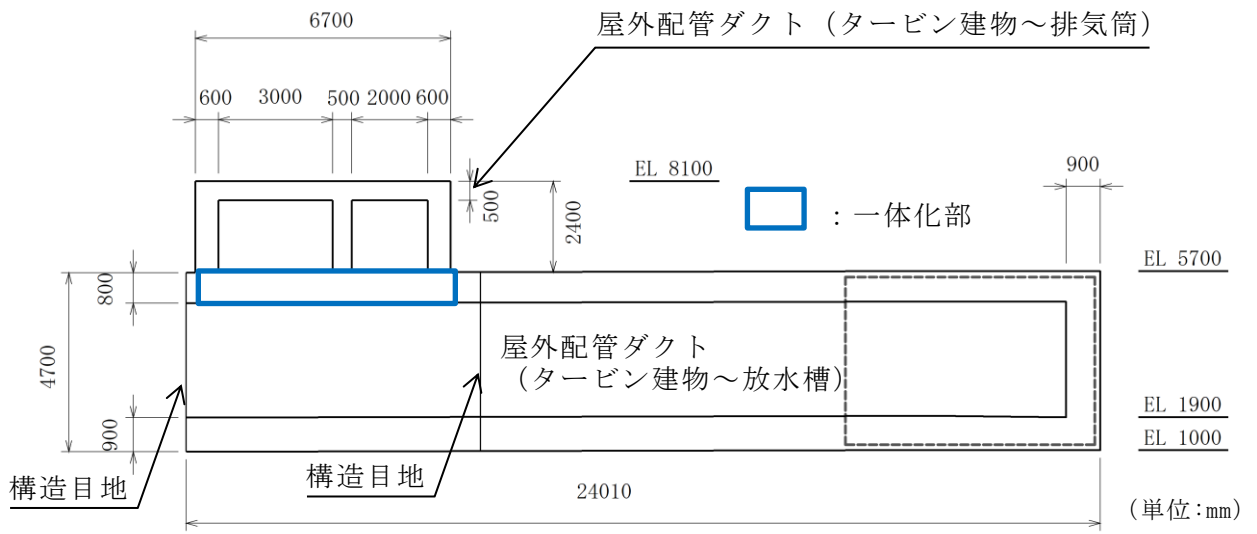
屋外配管ダクト (タービン建物～排気筒) 断面図 (B-B 断面)
